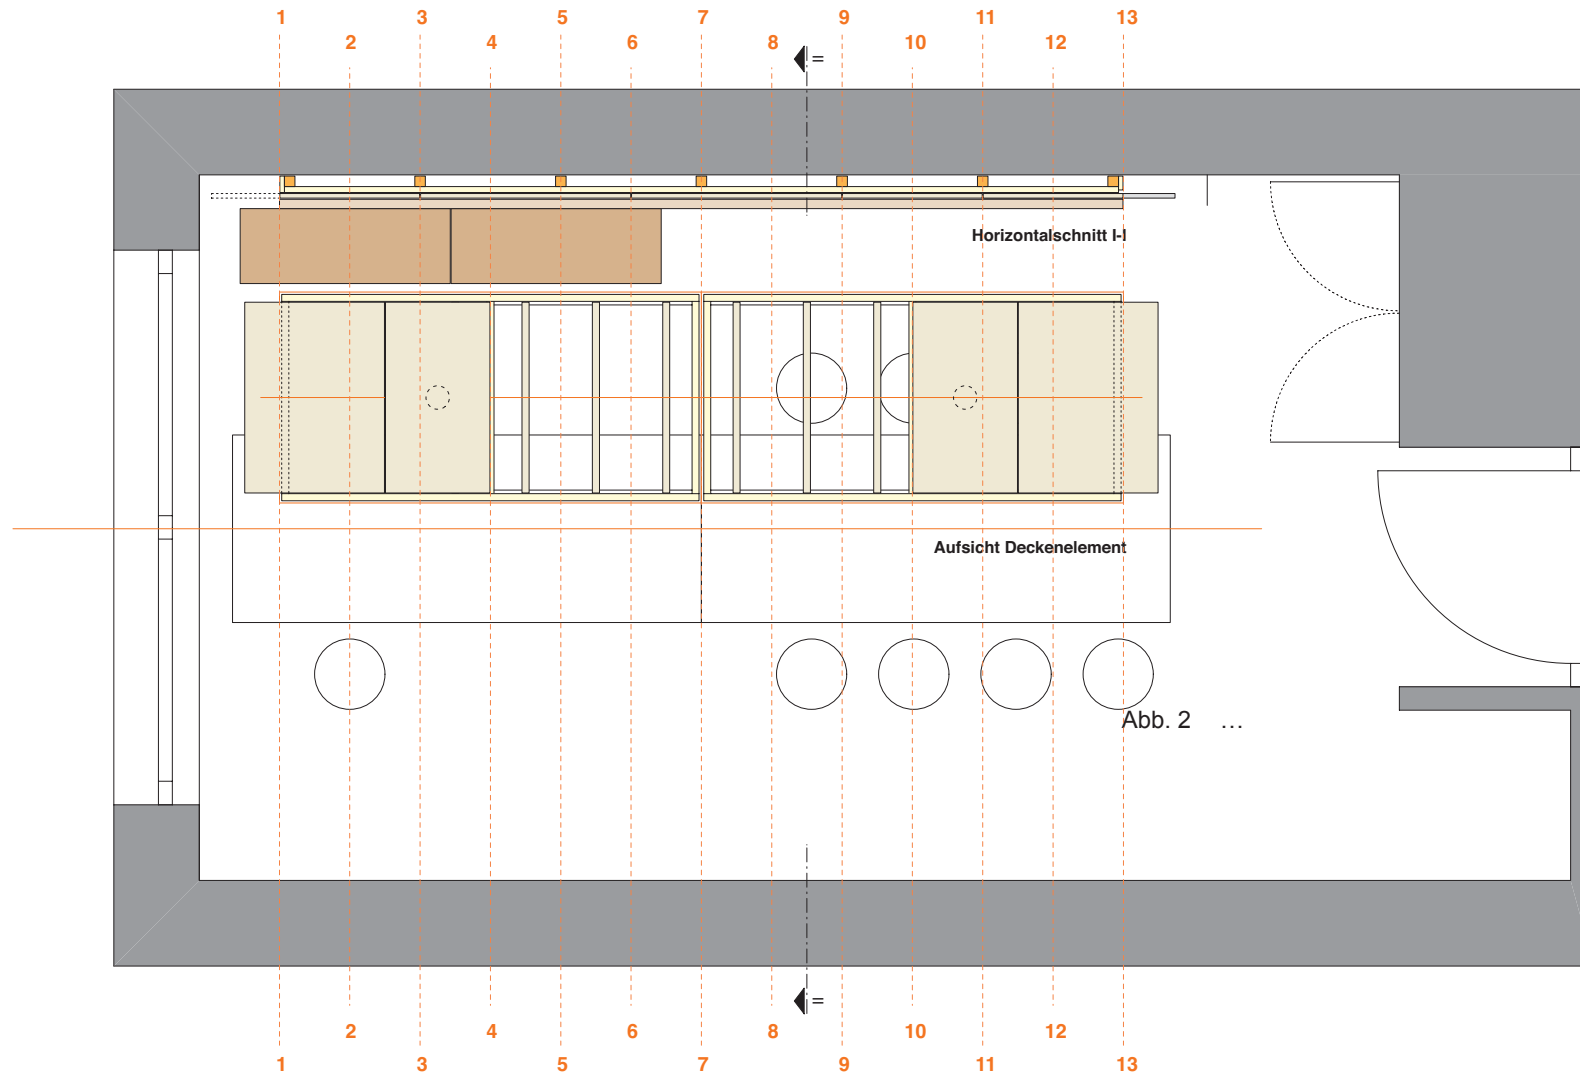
Horizontalschnitt durch Wandelement kombiniert mit Aufsicht Deckenelement M 1:30
